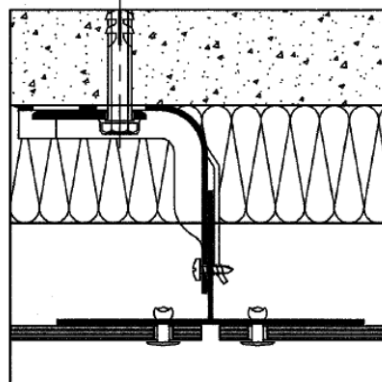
Angle extérieur (vue en coupe horizontale)
